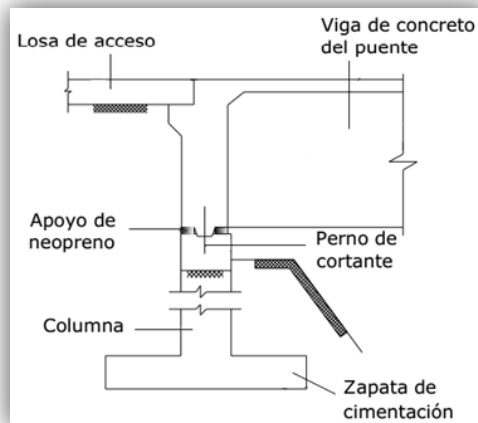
Estribo integral, con neopreno fijo y móvil, sobre columna o zapata de fundación
